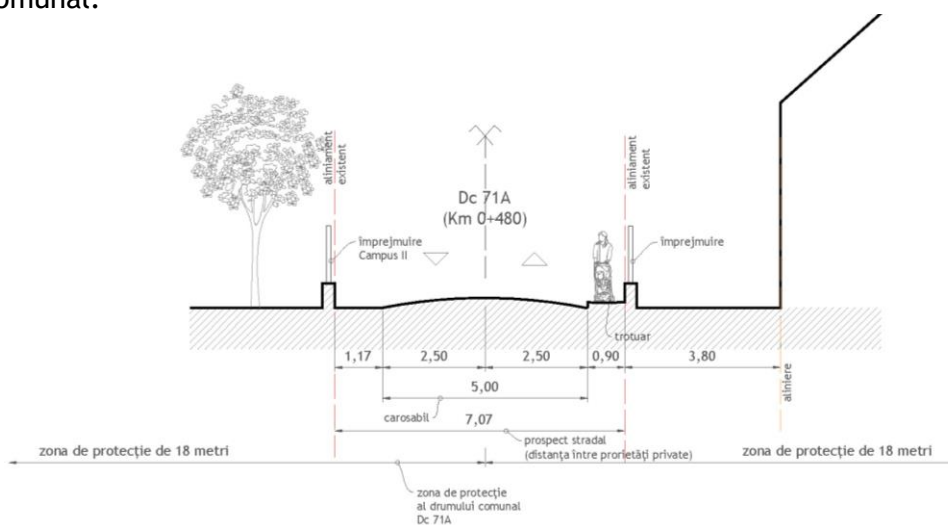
Secțiune prin Dc 71A, poziția kilometrică „km 0+480”
